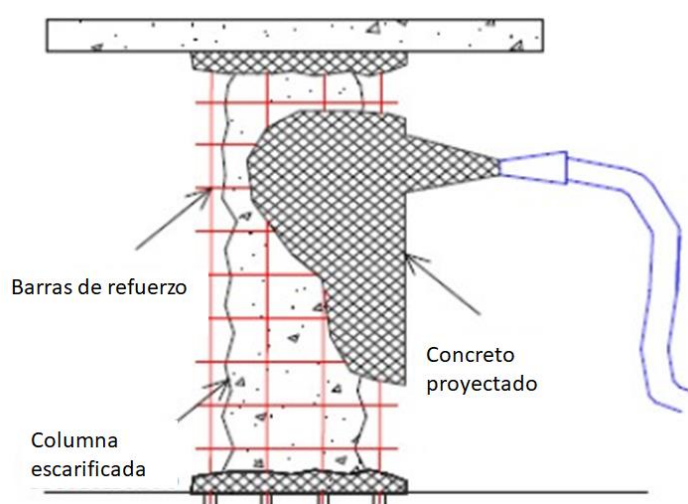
Refuerzo con utilización de concreto proyectado (TAKEUTI, 1999 Modificado).
